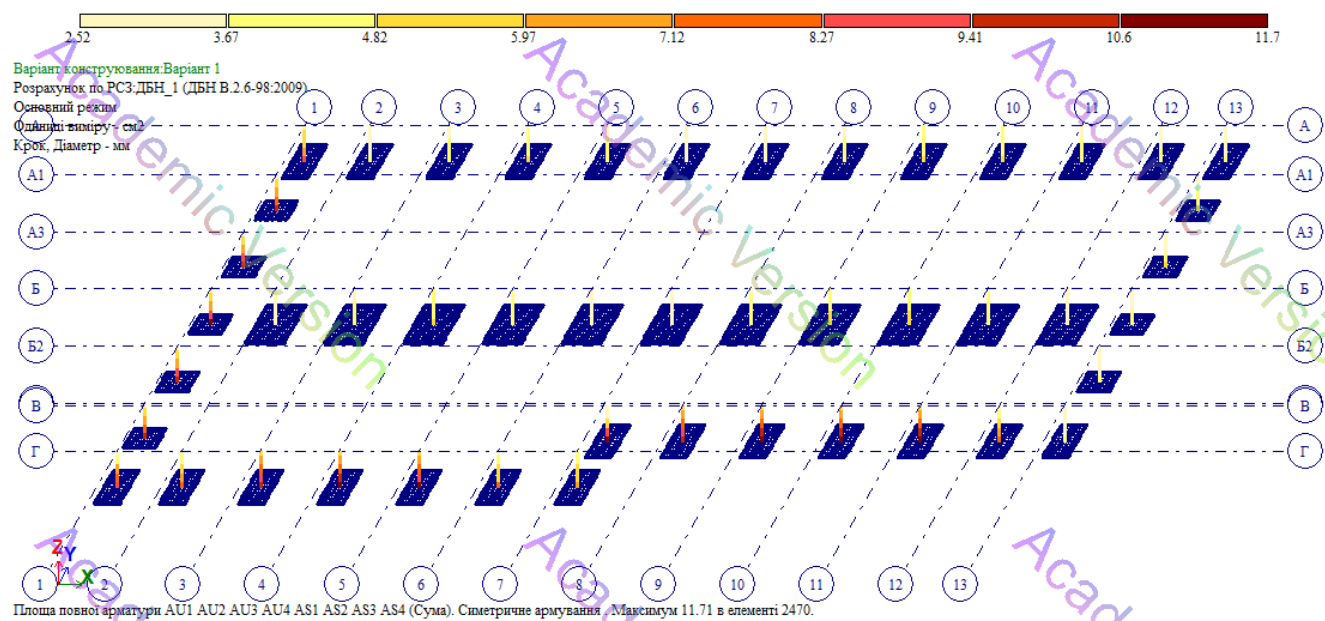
Теоретичне сумарне значення площі поздовжнього армування стовпців фундаменту
